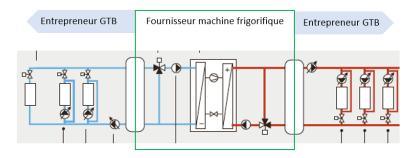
Le fournisseur des machines thermofrigorifiques est responsable de la régulation de la production jusqu'au séparateur hydraulique sur le côté chaud et sur le côté froid. En outre, le post-refroidissement est réalisé par le fournisseur de la machine thermofrigorifique.
